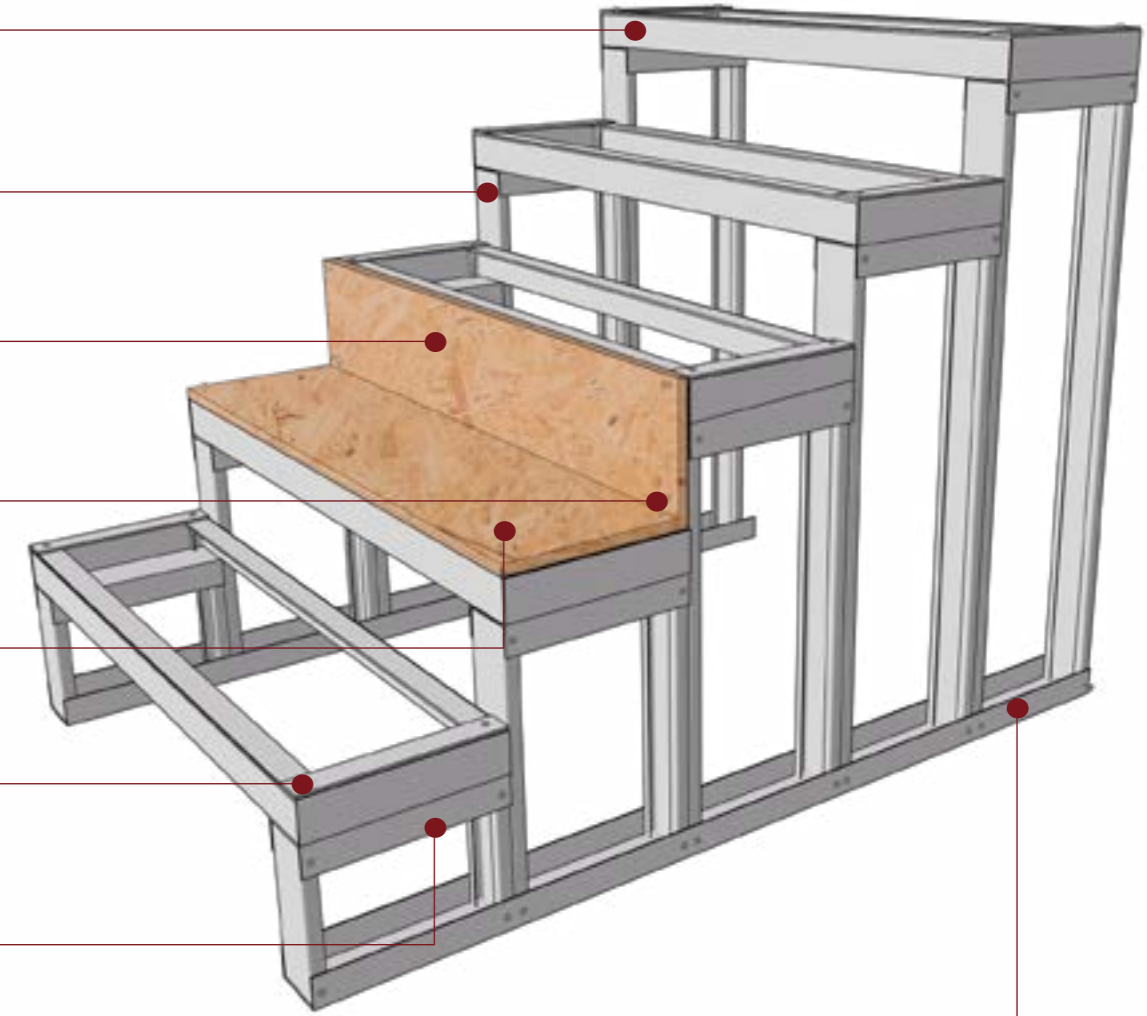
Imágen_Detalle Steel Frame, Gradas
